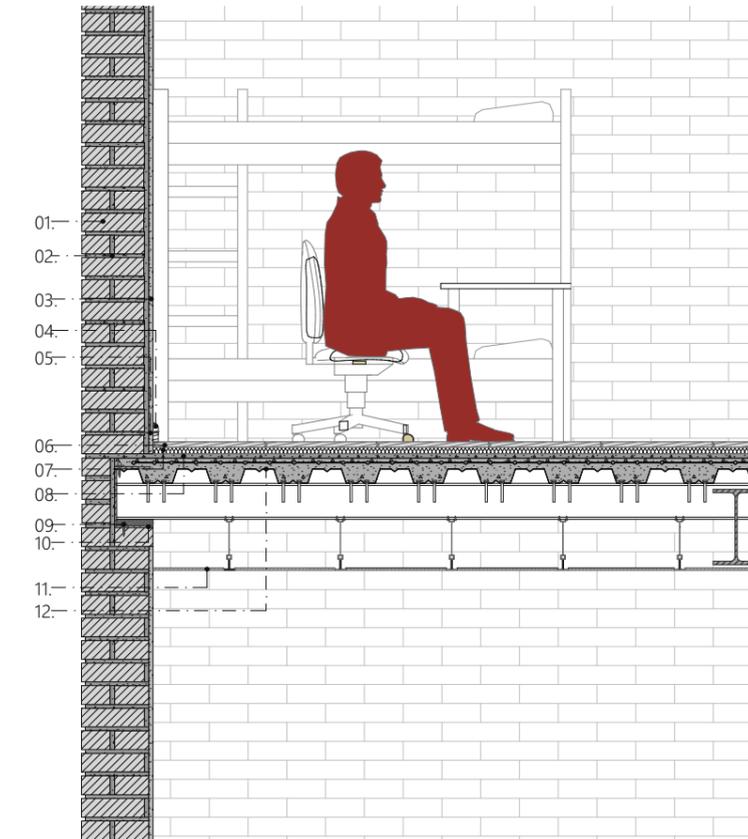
Detalle constructivo Gráfico: Elaboración propia
